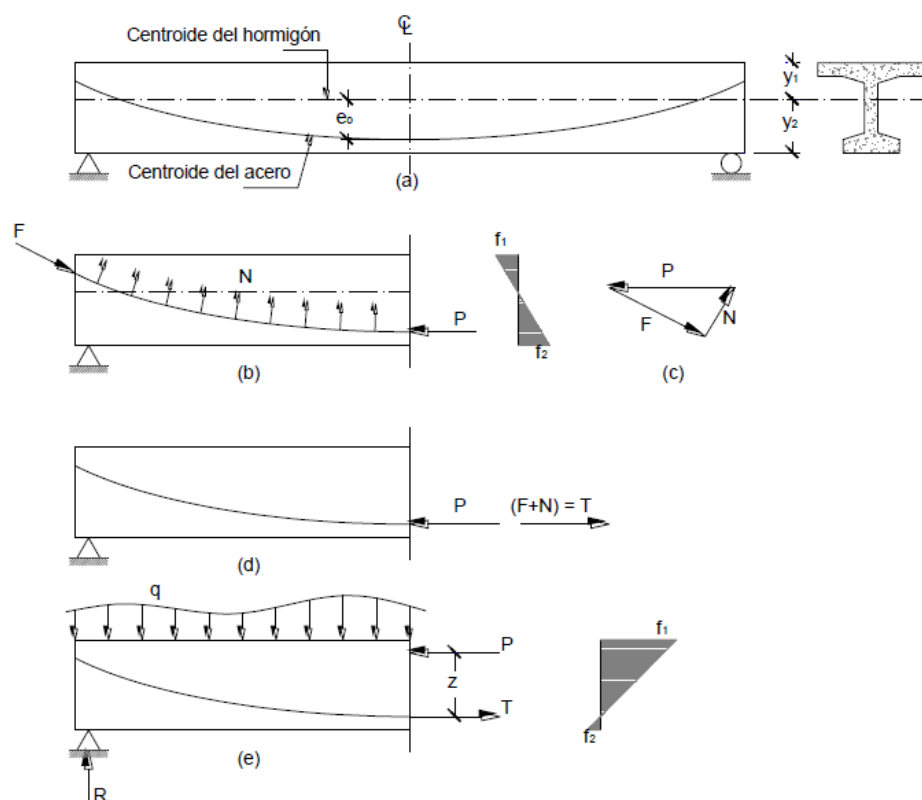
Fuerzas que actúan en una viga de hormigón presforzado típica (Tomado de Villavicencio, 2013)
